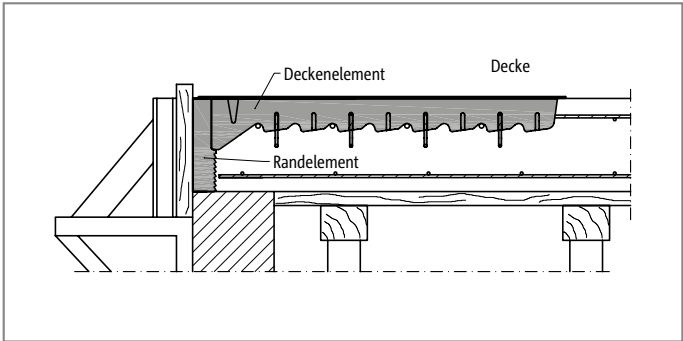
Schöck IDock® 1: Außenwand als direktes Auflager (kein Randunterzug); die Deckenaussparung wird durch die beiden Elemente Randelement und Deckenelement abgeschalt
